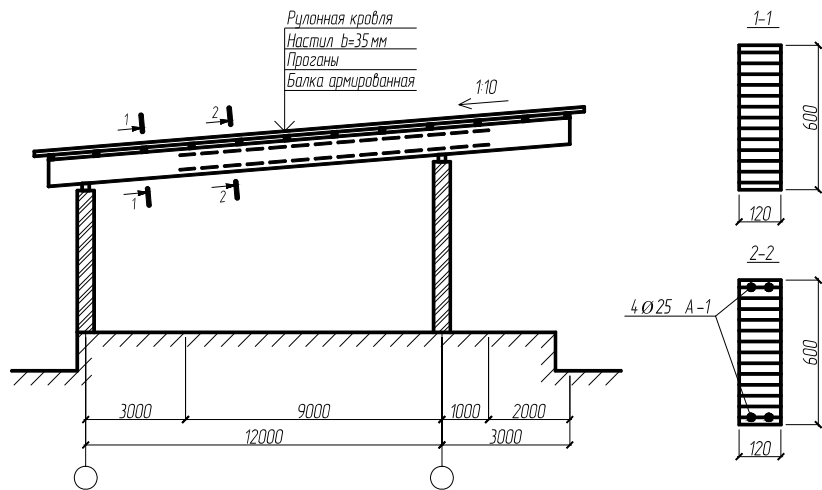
Клееные армированные балки переменной жесткости в покрытии складского здания (г. Владимир)
